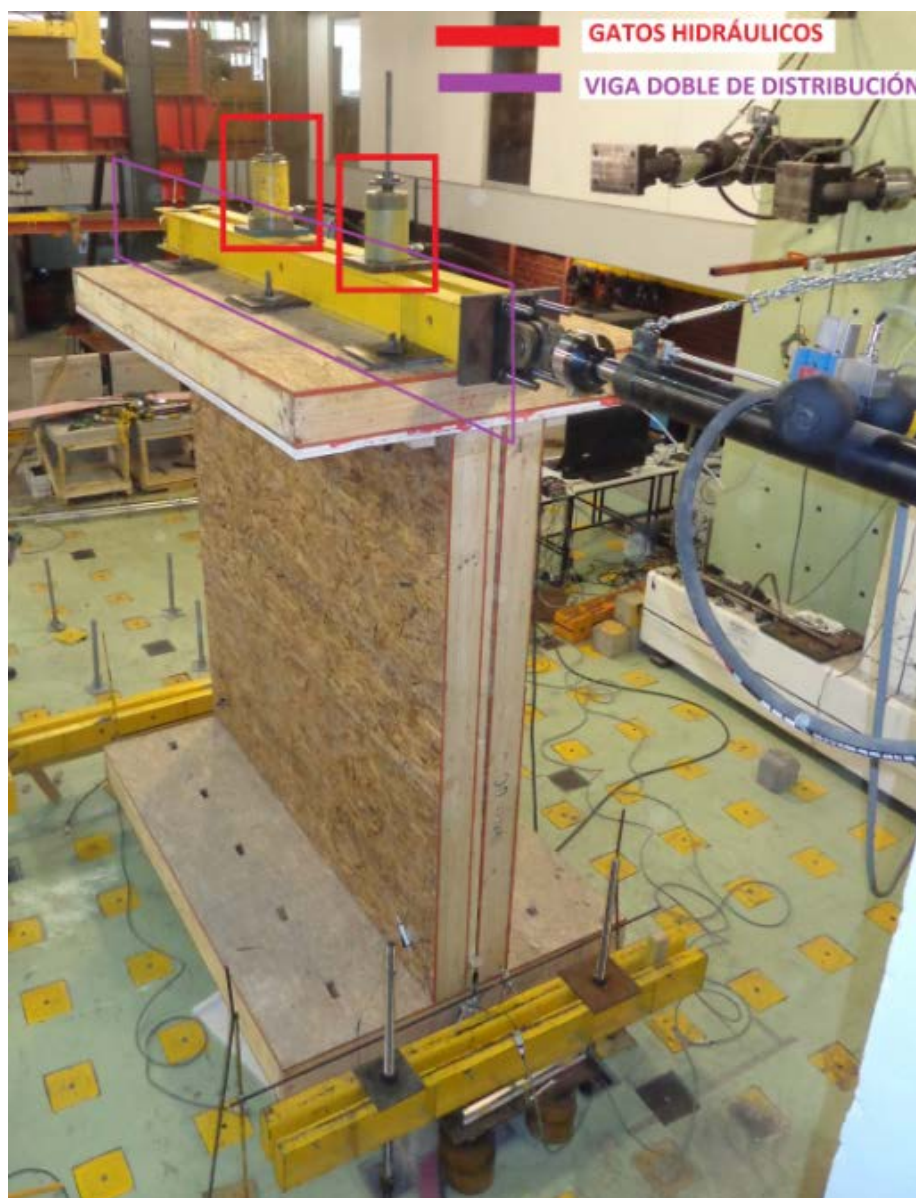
Vista Superior del Muro No. 1 con ubicación de gatos de aplicación de carga axial y viga doble de distribución.
